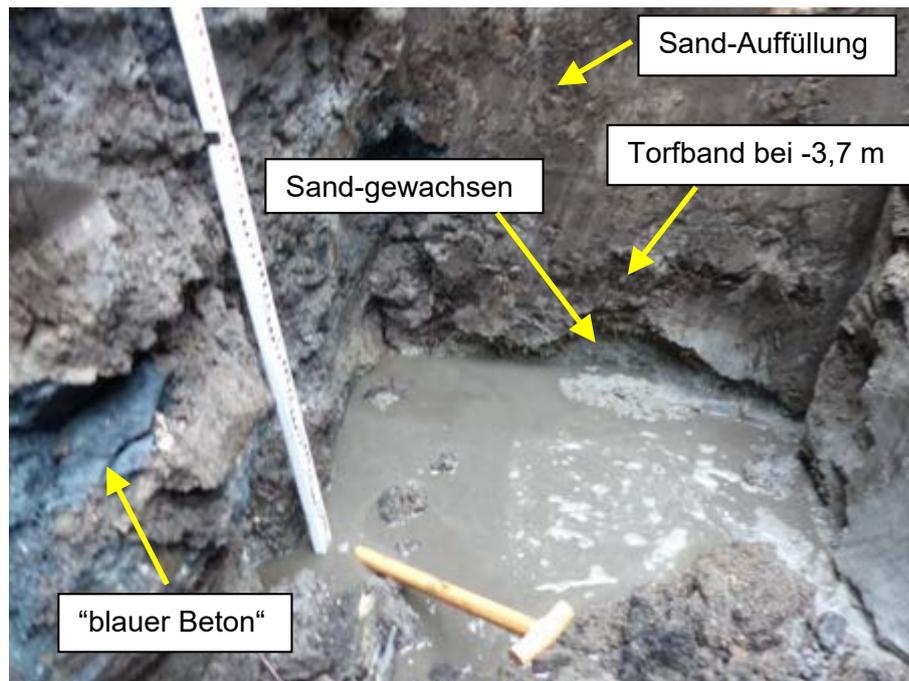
Schurf 2 – Wandfuß, Wandunterkante
